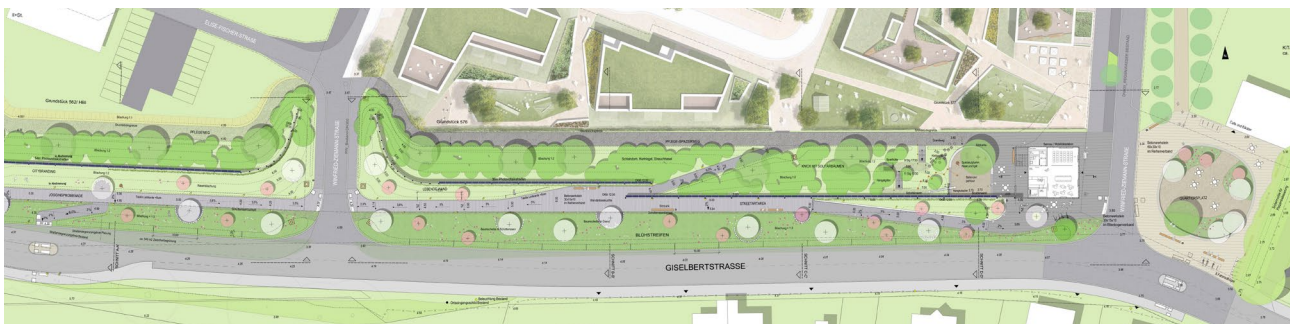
Lageplan Lärmschutzlandschaft, Ando Yoo Landschaftsarchitektur
